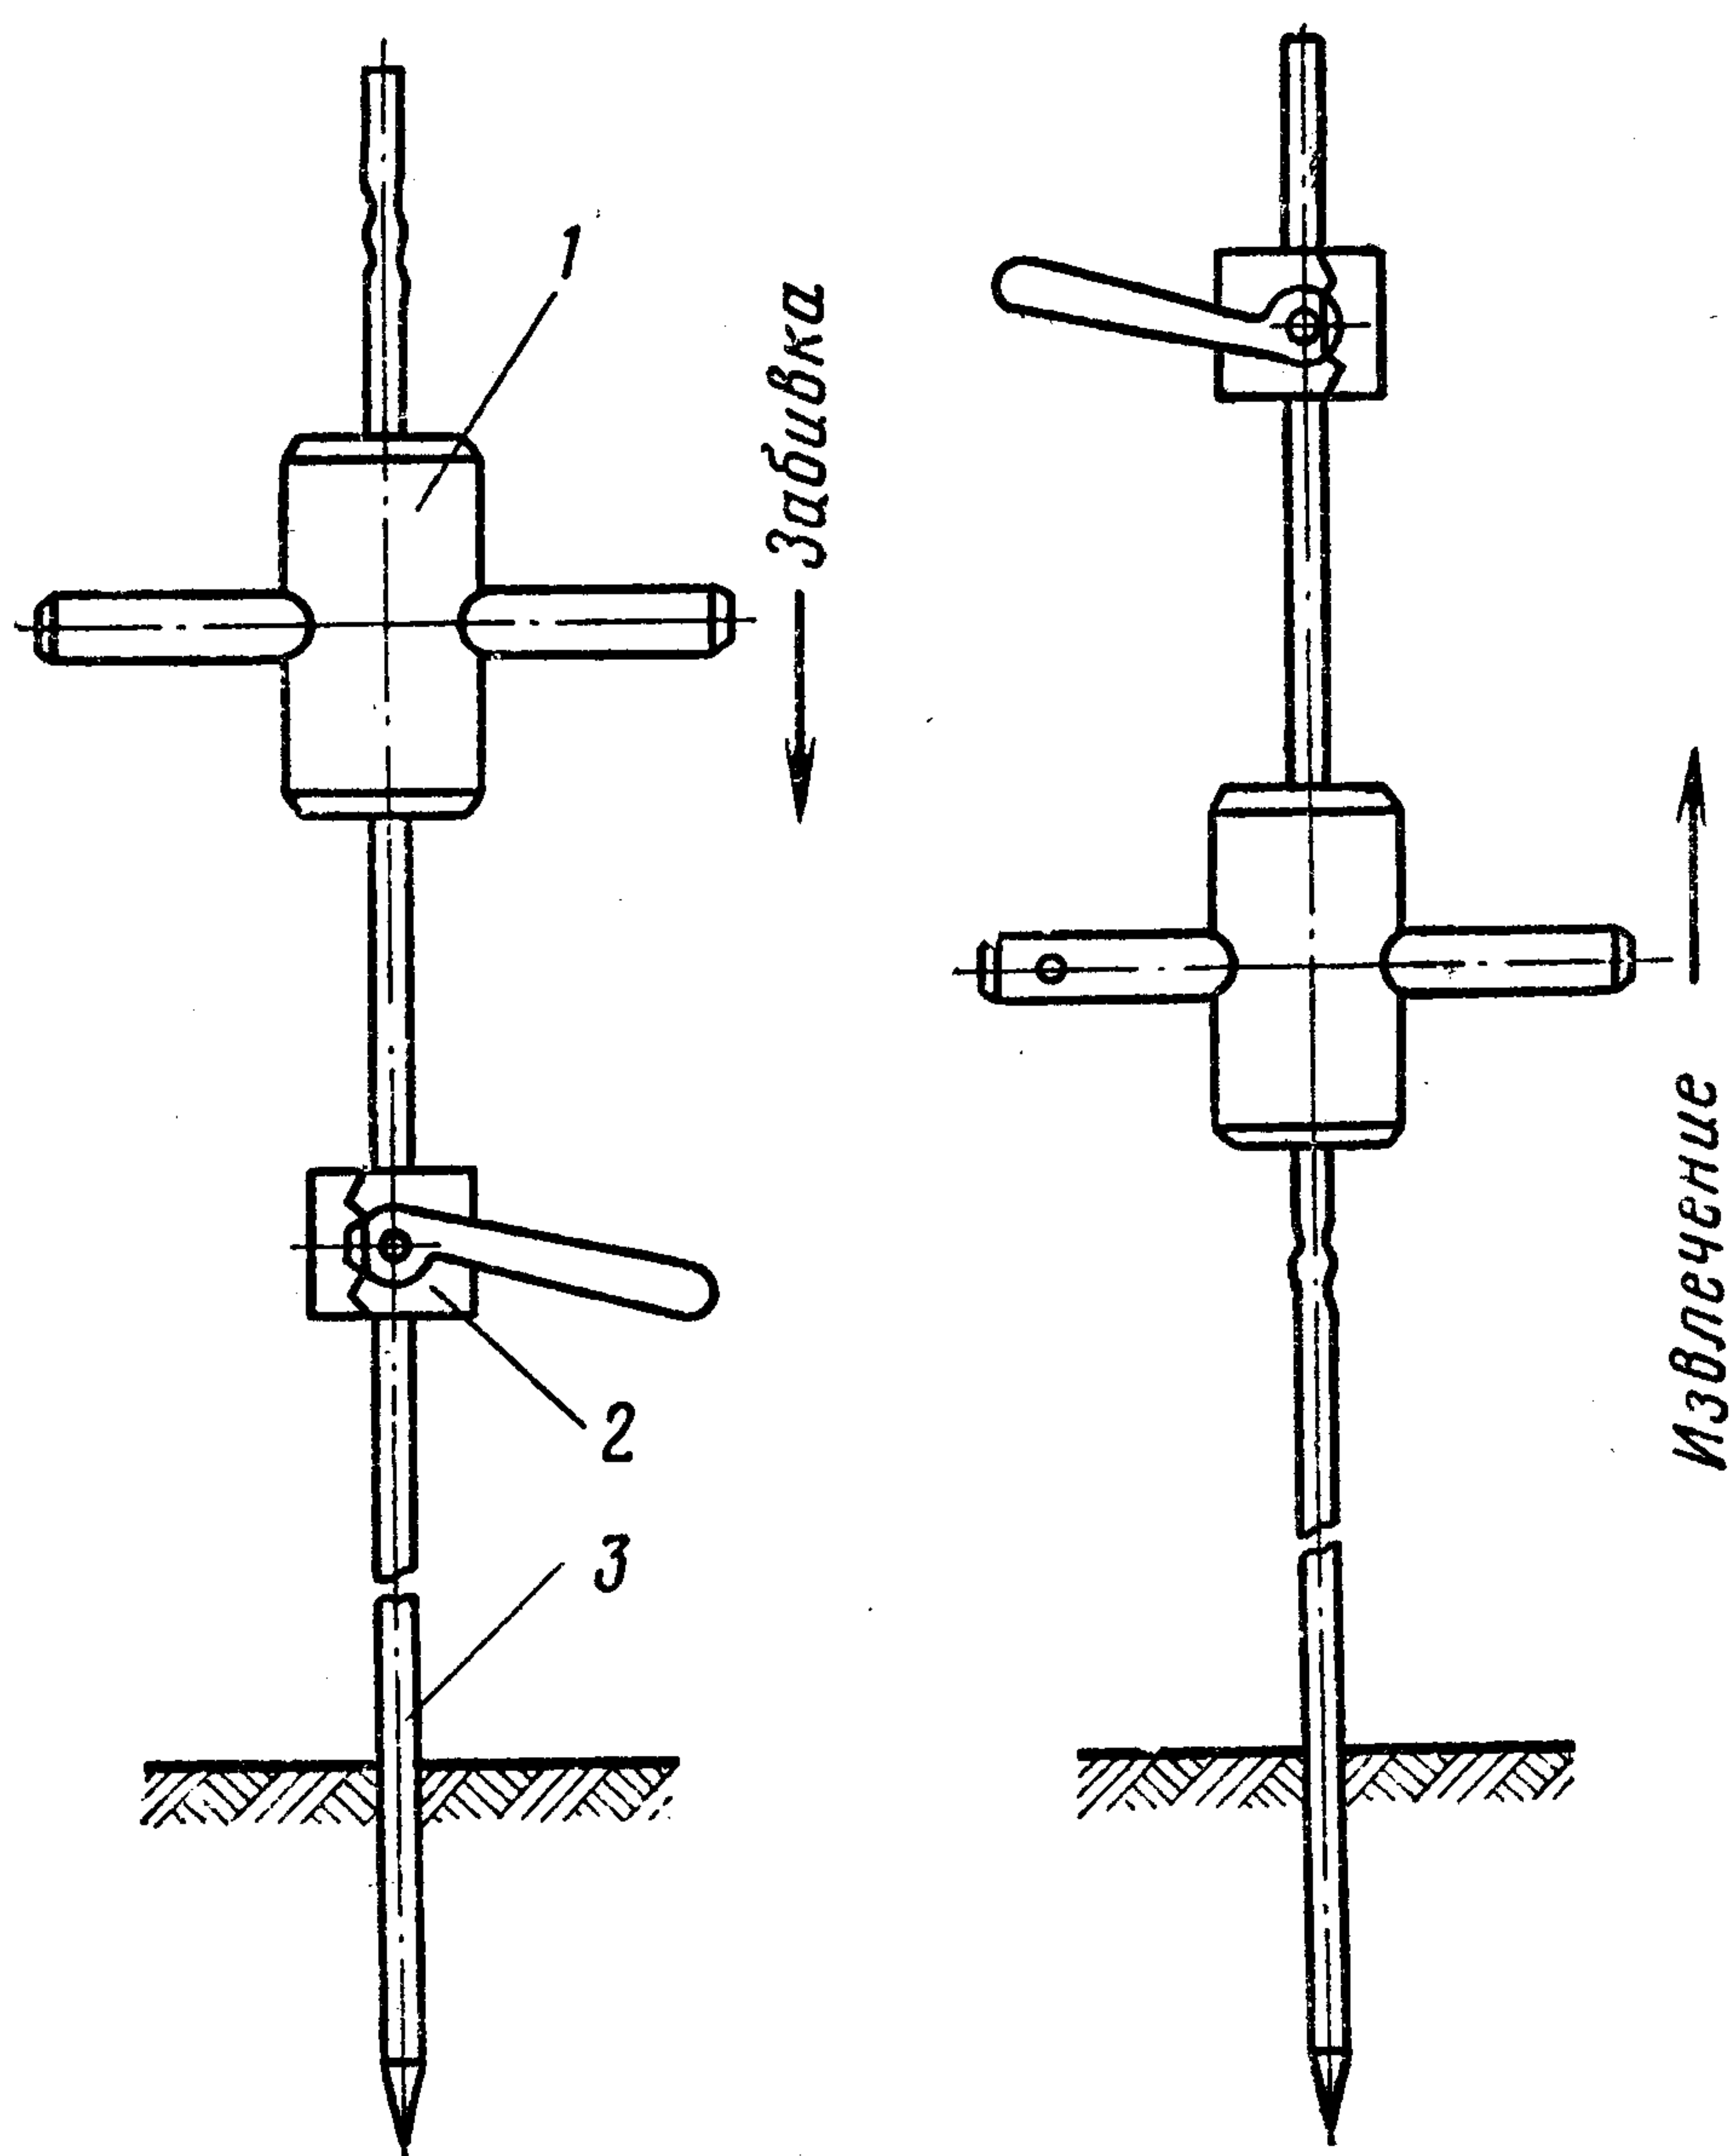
Устройство для забивки и извлечения стержня стандартного заземлителя.
